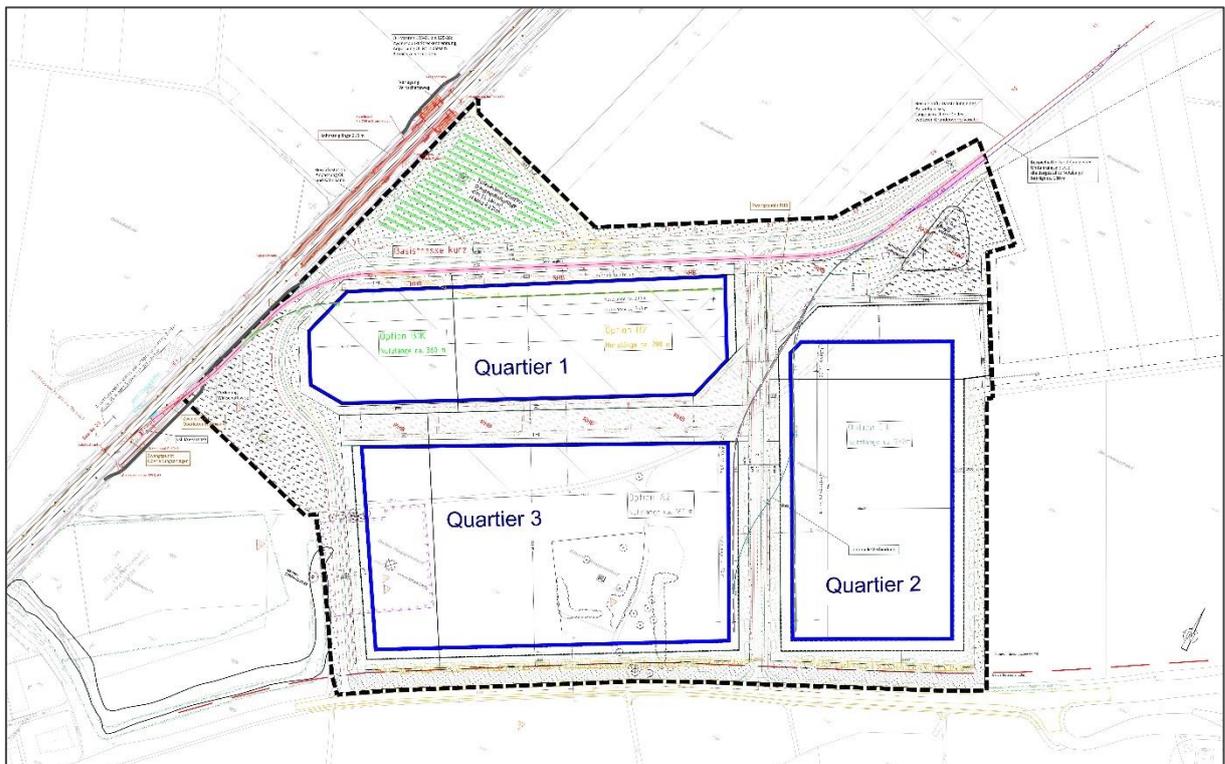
Gleisanlagenplanung IGI-Rißtal-Varante1, Quelle: DB Engineering & Consulting GmbH-Karlsruhe, Stand 26.01.2021
